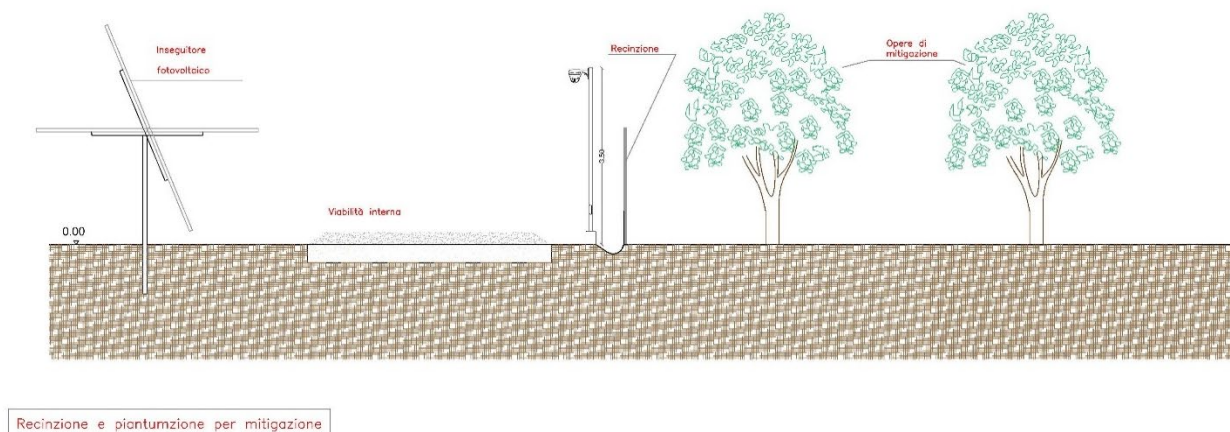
schema della fascia di rispetto con recinzione, elementi arborei e muretti
